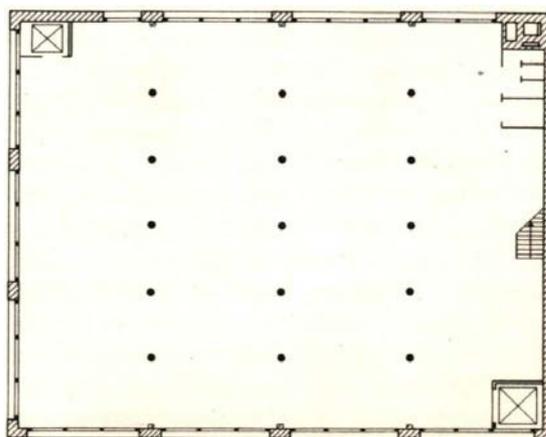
Ed. Leiter 1, Chicago, 1879. Planta
